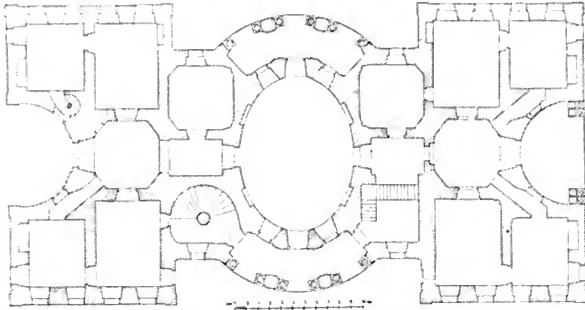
Liblitz. Grundriss des Schlosses.
